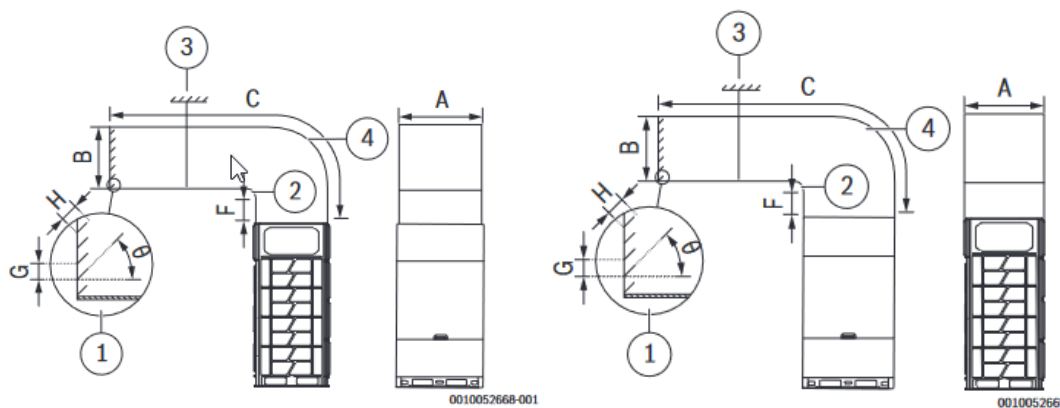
Condutas transversal (opção A) e Condutas longitudinais (opção B)
